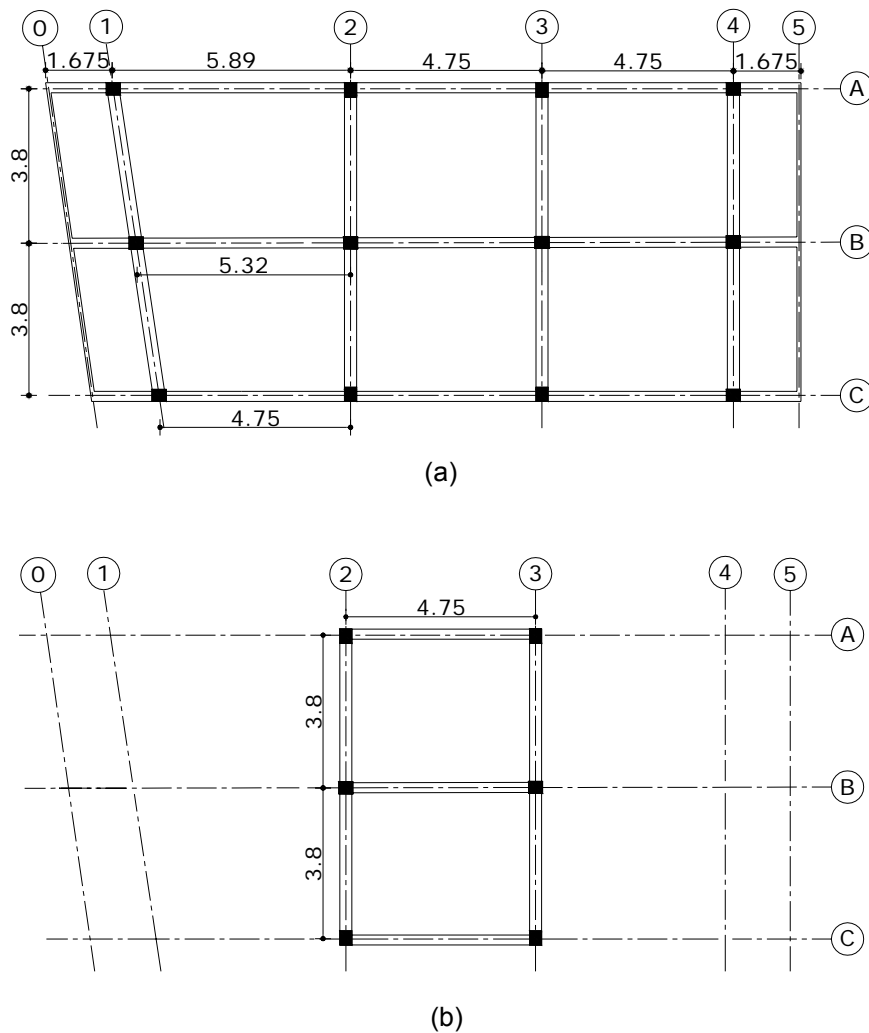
(a) Planta primer y segundo entepiso y (b) Planta attillo.
